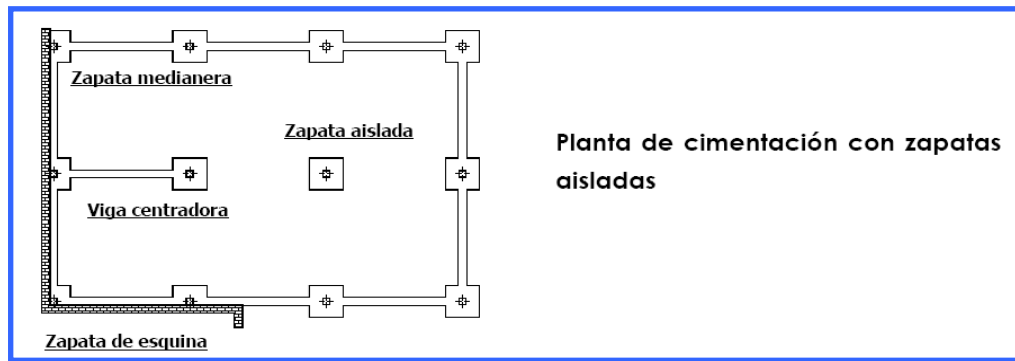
PLANTA DE CIMENTACIÓN CON ZAPATAS AISLADAS
